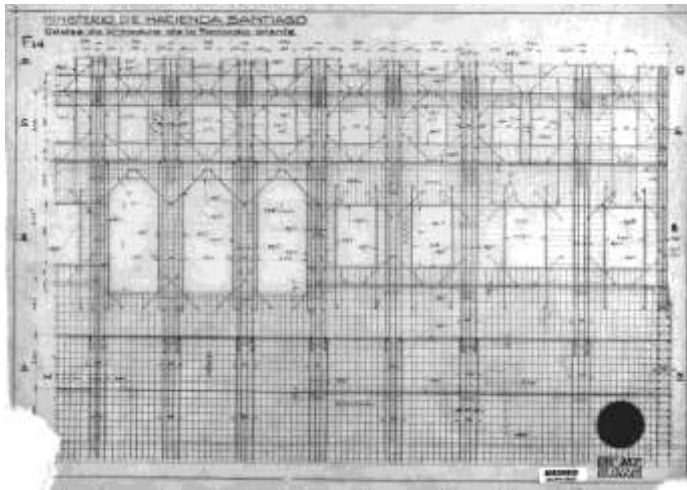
Izq. Elevación fachada principal oriente Plano de cálculo estructural y detalle respectivo. Archivo Digital Ministerio de Obras públicas.
